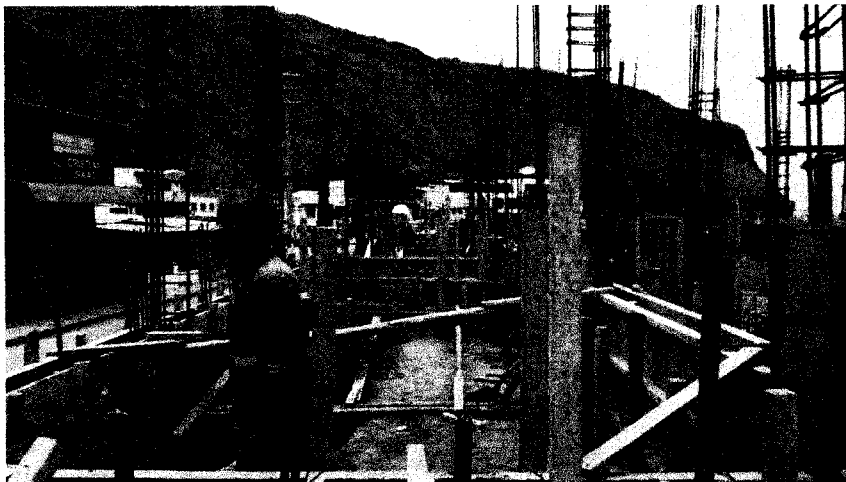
Encofrado de sobre cimiento zona de desinfección.
